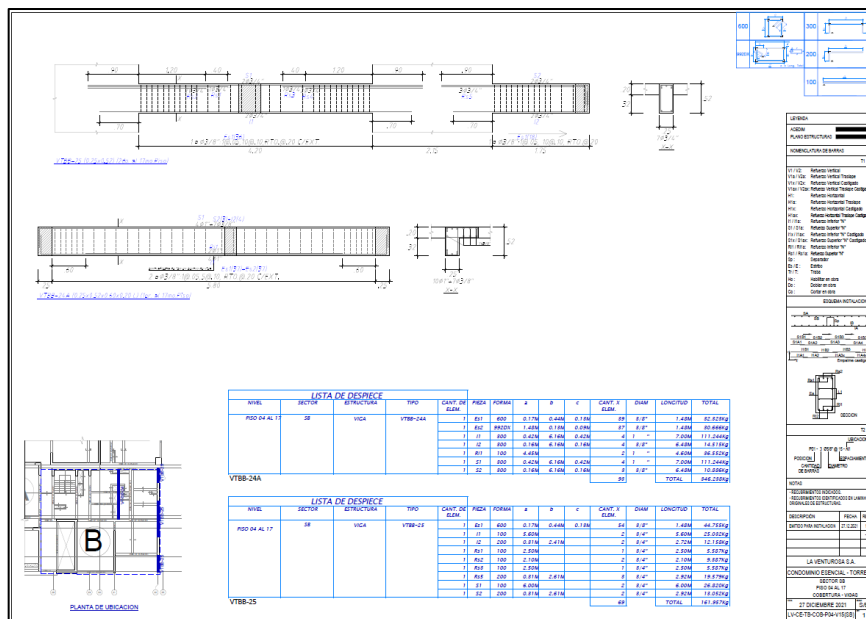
Plano de instalación de Viga del Piso 04 – Condominio Esencial Torre B. Fuente: TSC Innovation
